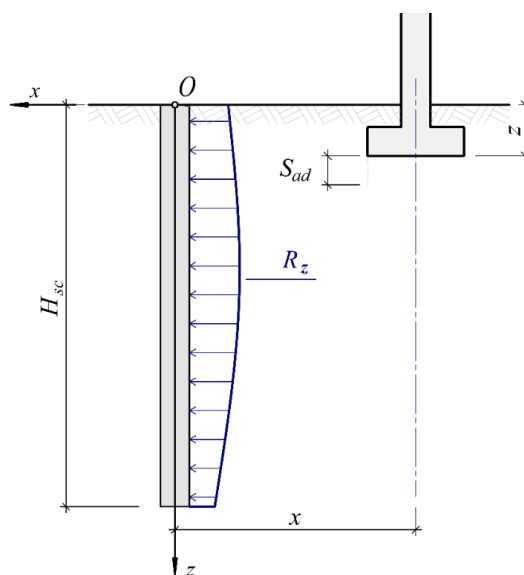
Расчетная схема к определению дополнительной осадки фундамента.
